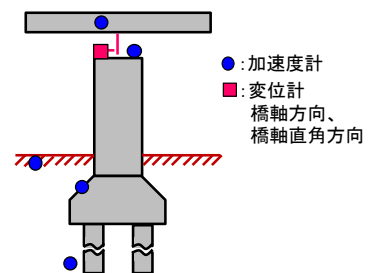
対象橋梁の側面図および強震観測装置の設置位置図
